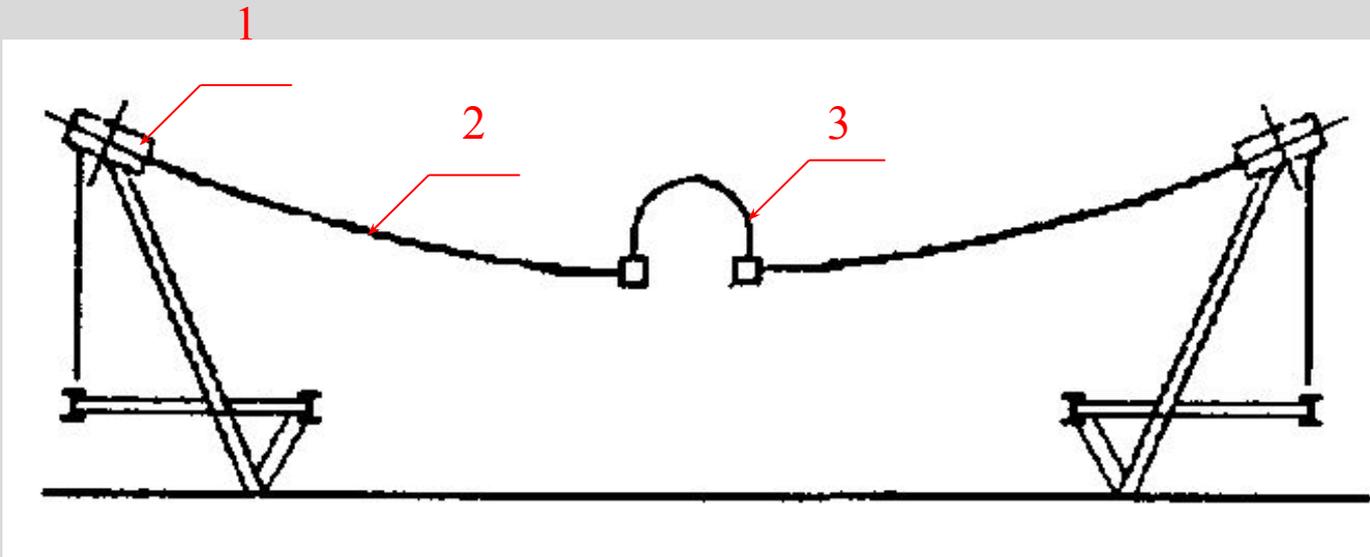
Схемы покрытий зданий круглых в плане:
